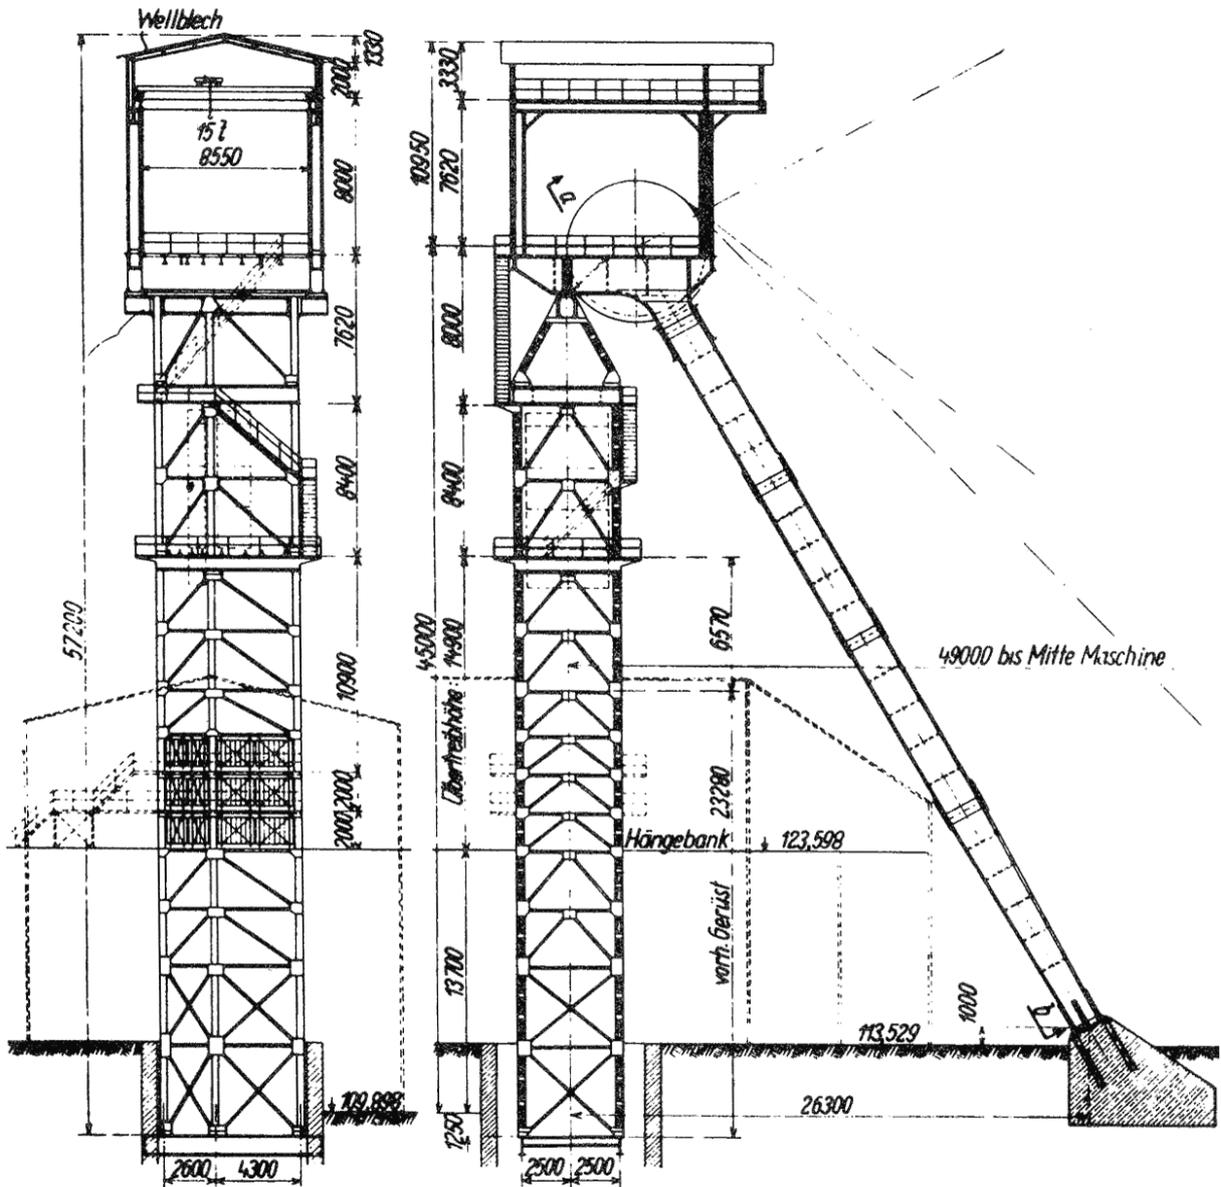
Schnittzeichnung des neuen Fördergerüsts von Schacht Arnold. Links das Gerüst in einem ersten Planzeichnungsentwurf. Die Bauausführung wurde bei der Dachkonstruktion aber ein wenig abgeändert.
